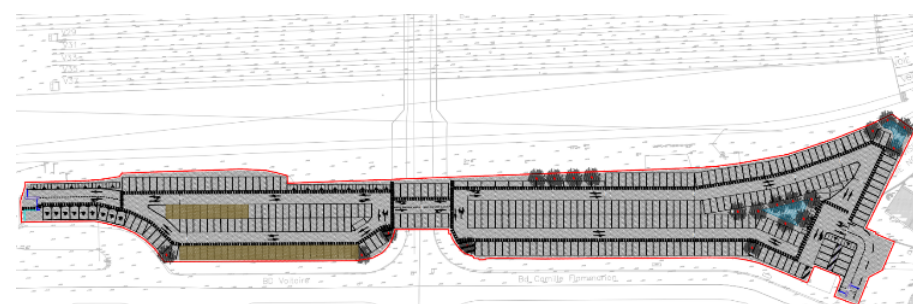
Plan de masse du parking provisoire boulevard Flammarion (source : Etude APS1, AREP / SNCF Gares & Connexion, 2024)
